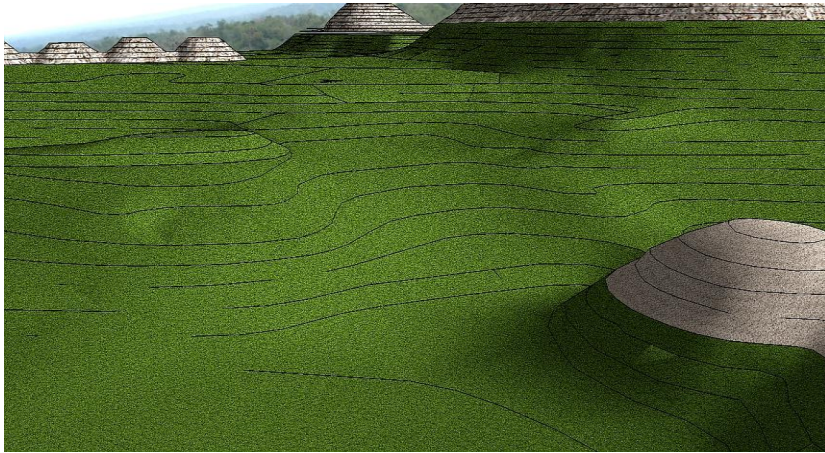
D 29: Segunda Aproximación de la Calzada Galindo. Vista Sur.
